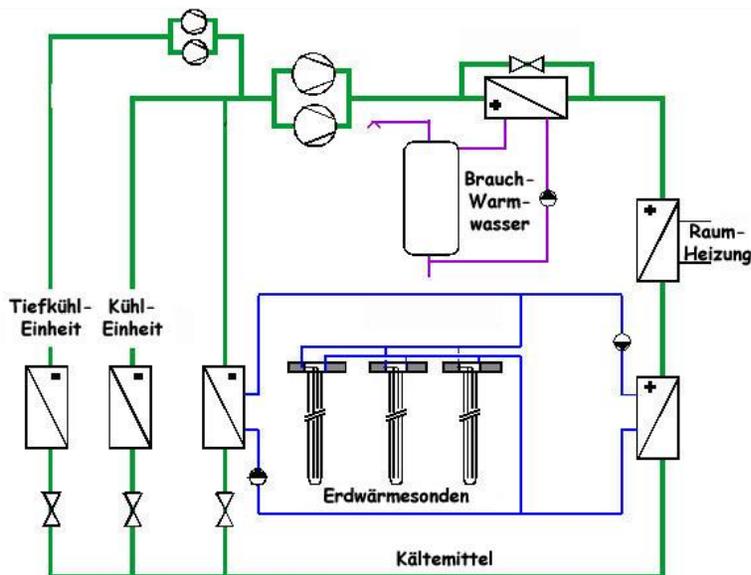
Vereinfachtes Funktionsschema einer von KWT für ein Restaurant⁵⁷ gebauten Anlage mit kleinem Erdwärmespeicher zur kombinierten Heizung und Kühlung [Good et al. 2001]
